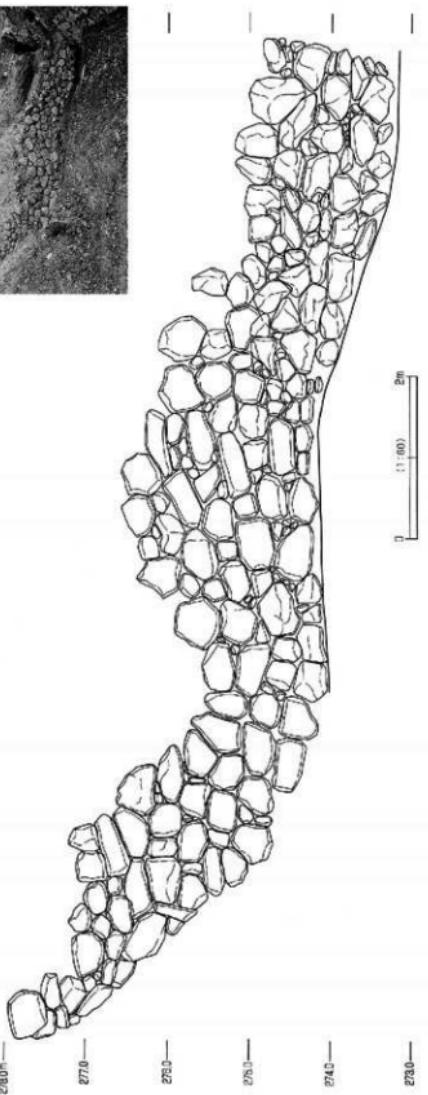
山手門東 清水曲輪石垣：土橋東面石垣平面図、側面図
